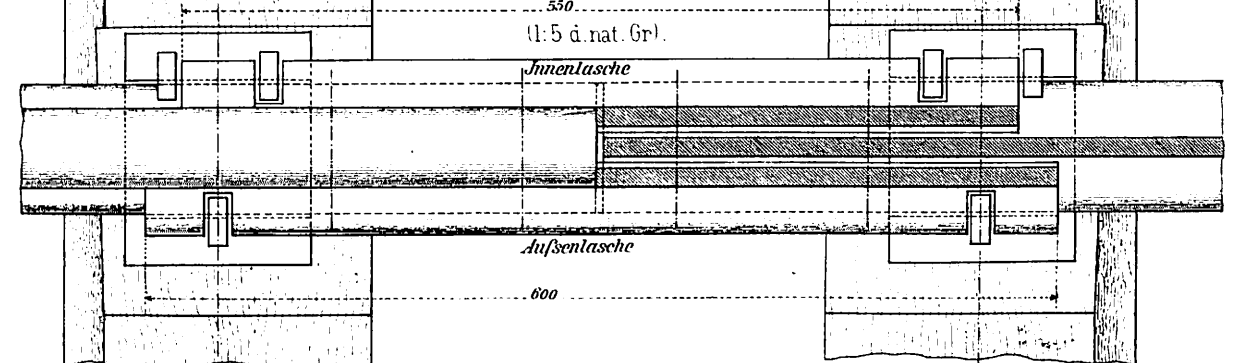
Grundriss u. Horizontalschnitt.
